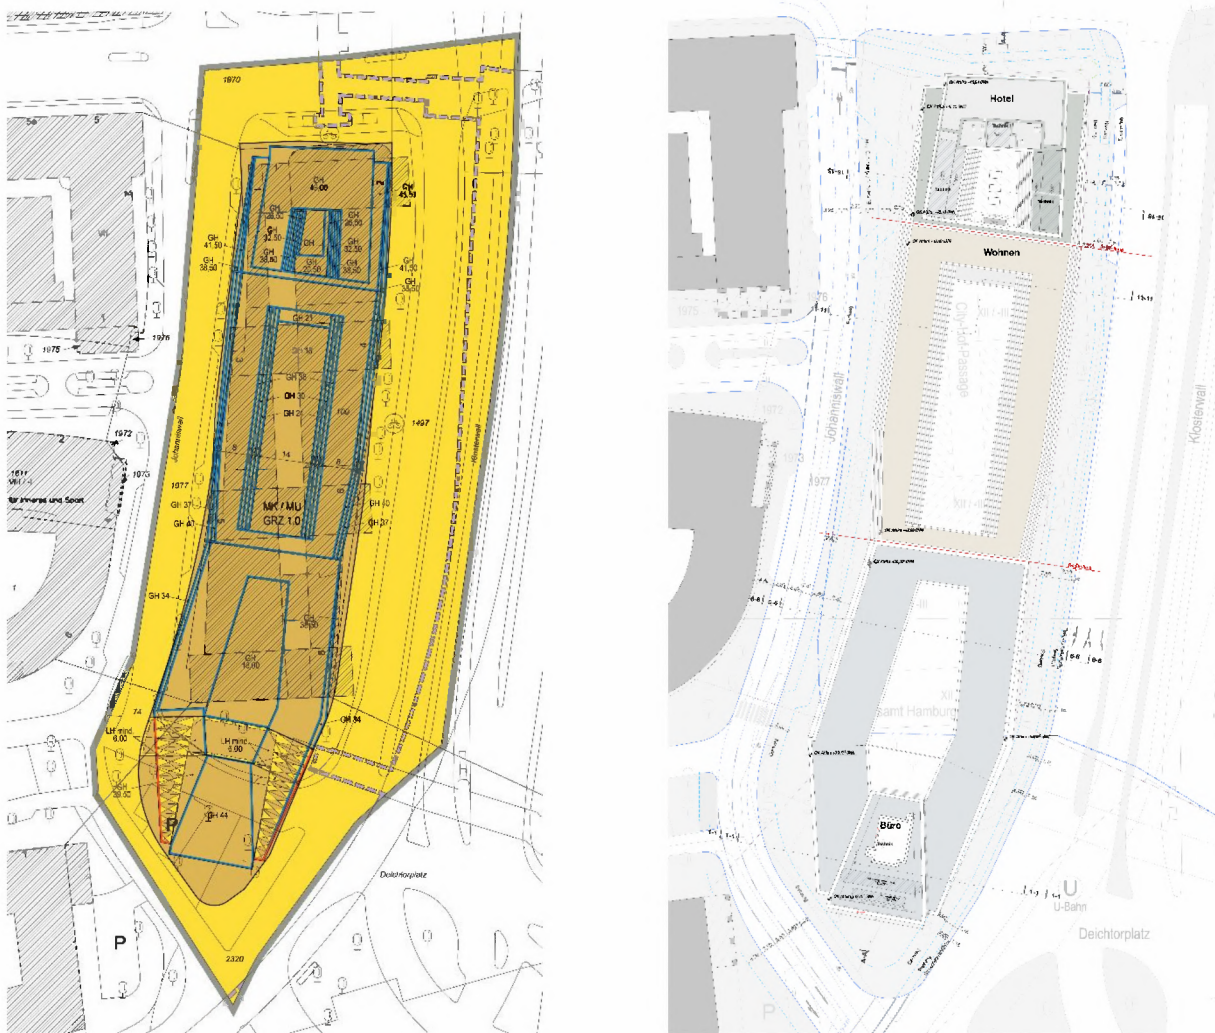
Bebauungsplanentwurf „Altstadt 49“ (links, Stand: Vorentwurf) und Grundriss Dachaufsicht des aktuellen Bauentwurfs (rechts).
